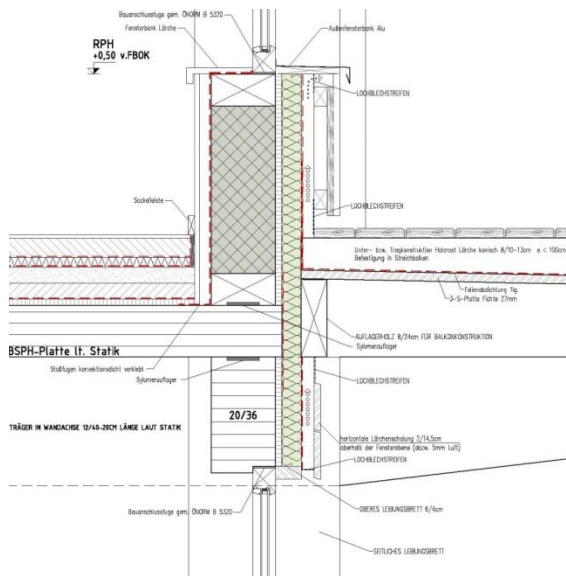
Anschluss Parapetbereich – Balkone Hotel Brennseehof
